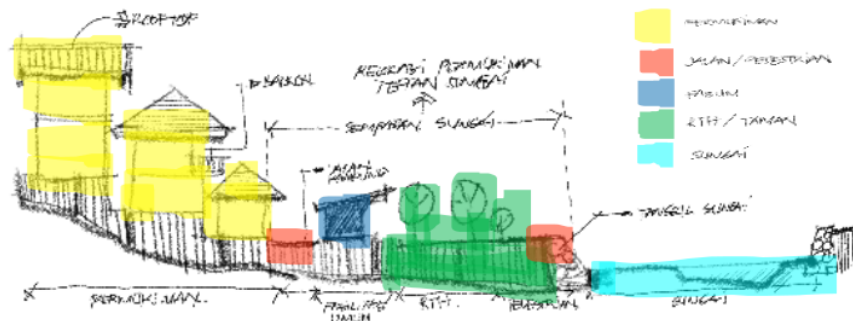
Penerapan sempadan sungai sebagai setback bangunan
